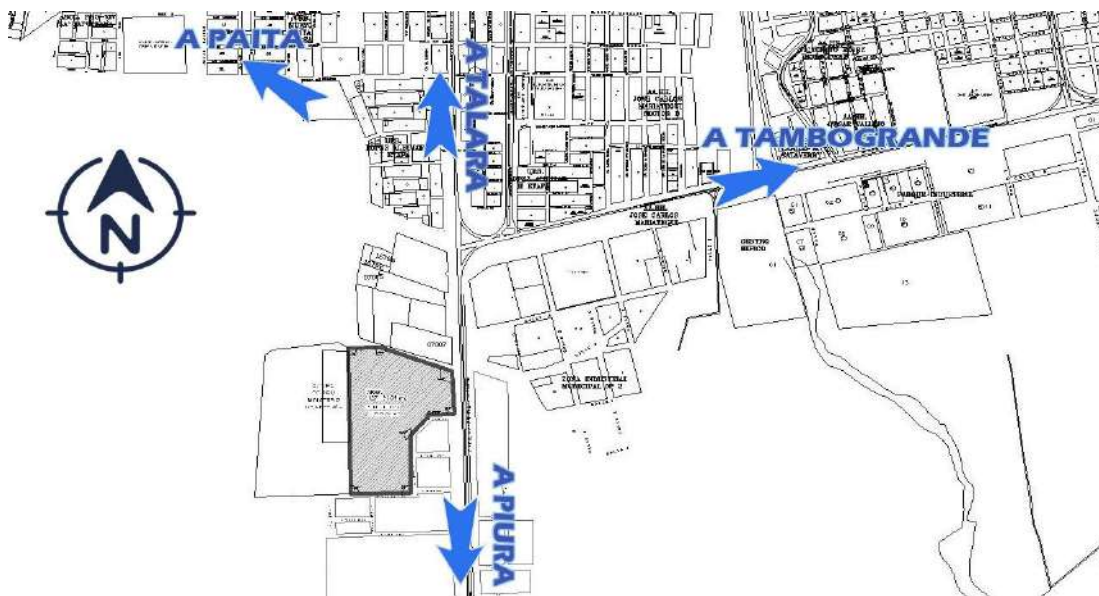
Plano de Localización del proyecto arquitectónico. Fuente: Elaboración Propia sobre la base de los planos del PDU.
